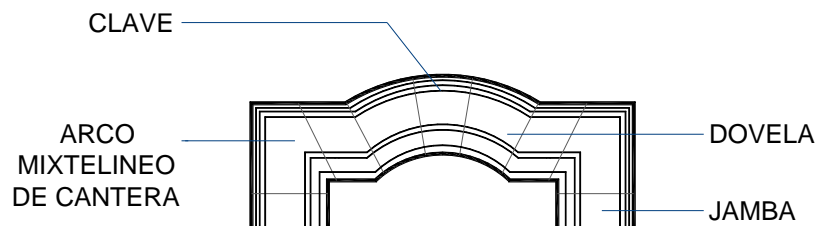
Detalle del cerramiento de las ventanas la fachada.
